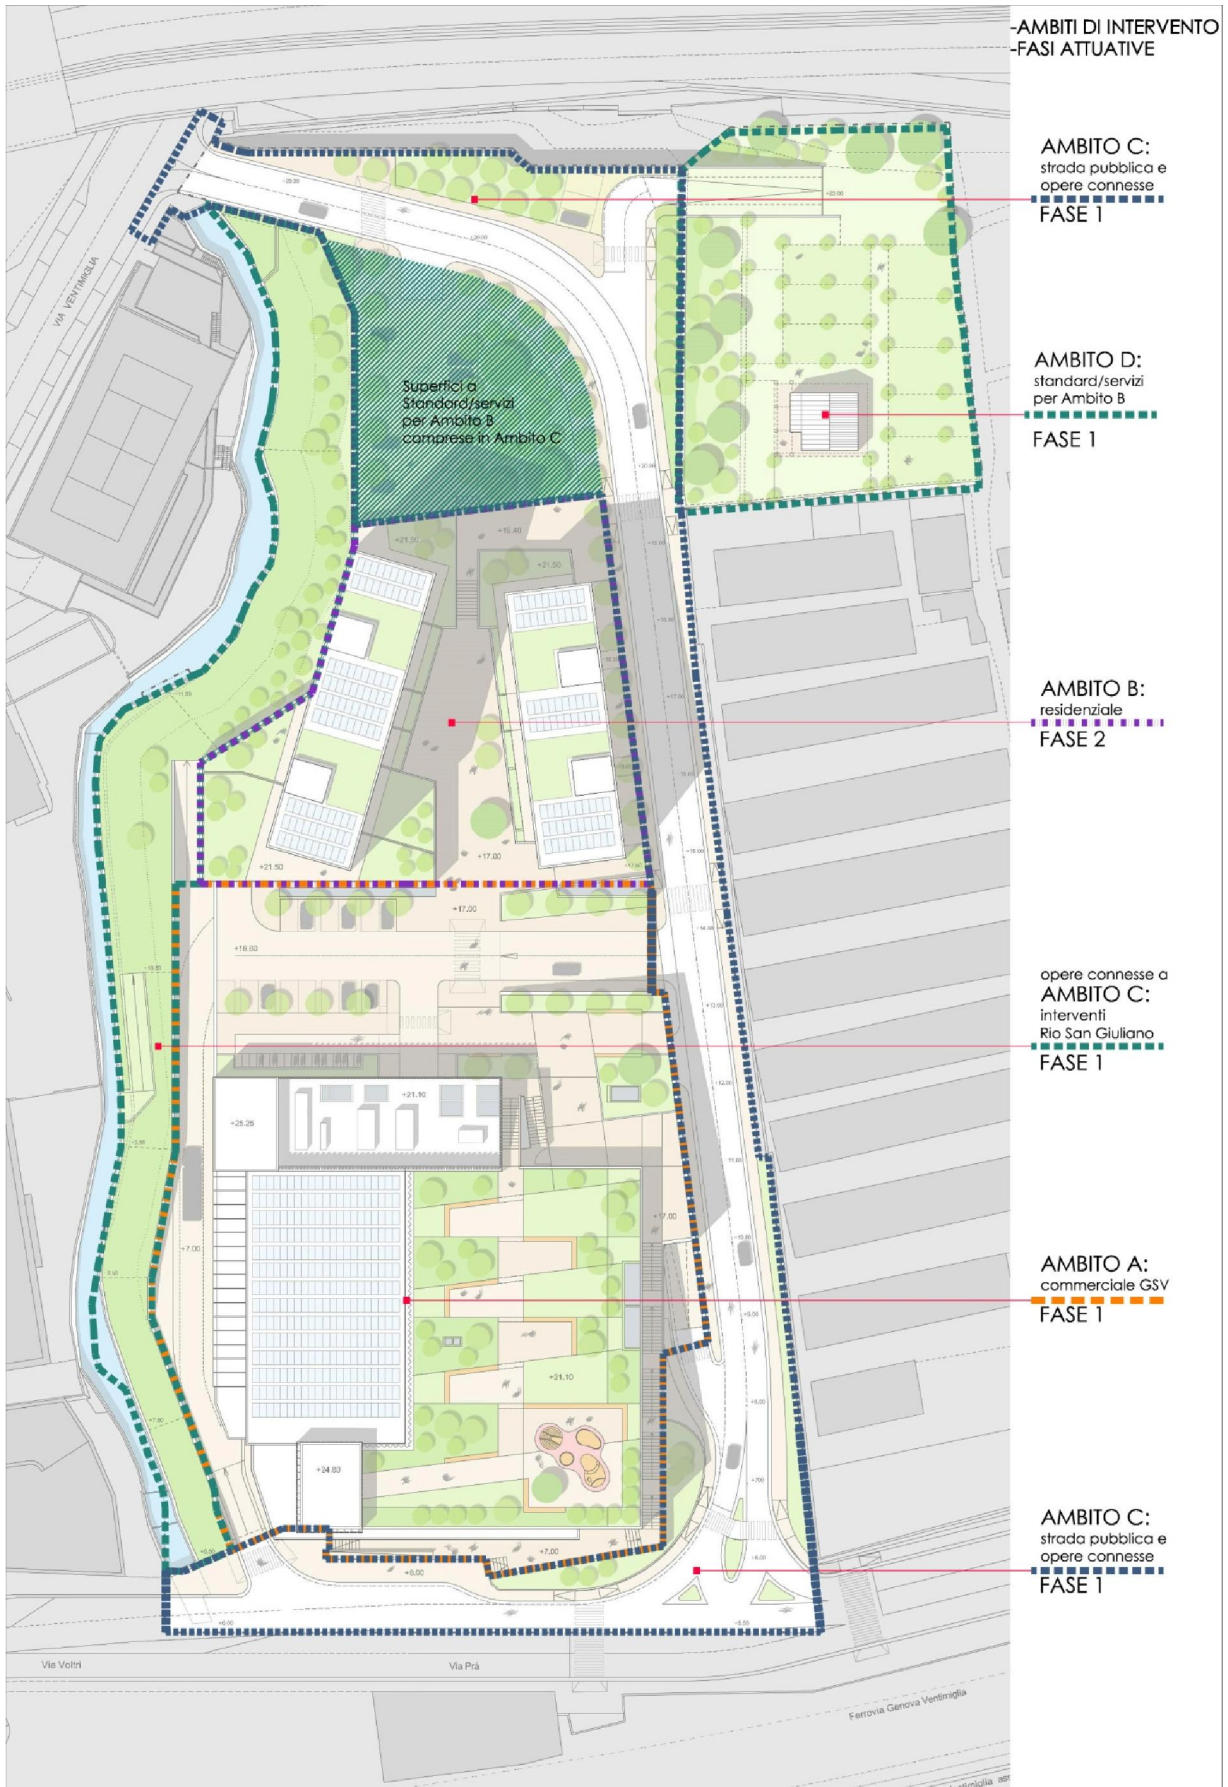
Planimetria generale di PUO con individuazione degli AMBITI di Intervento e delle FASI ATTUATIVE
